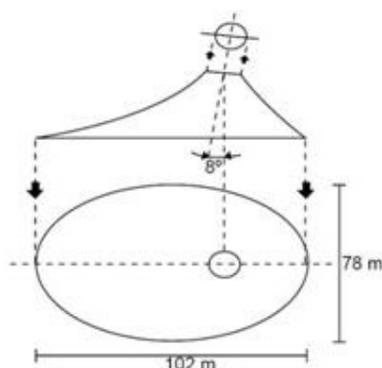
Sony Center; A) Planta da área da cobertura Sony Center, posição final do mastro; B) Detalhe do mastro inclinado, cabos de aço e da treliça prismática. Fonte: autores, 2006.
